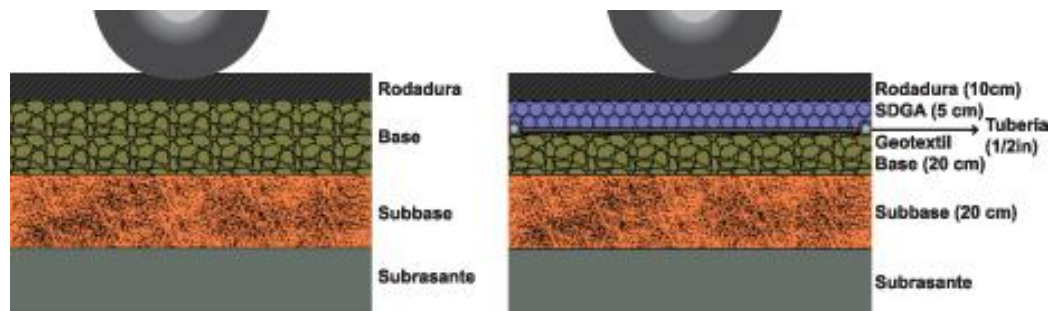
Esquema de pavimento flexible, (Reyes Liscano, 2011).
